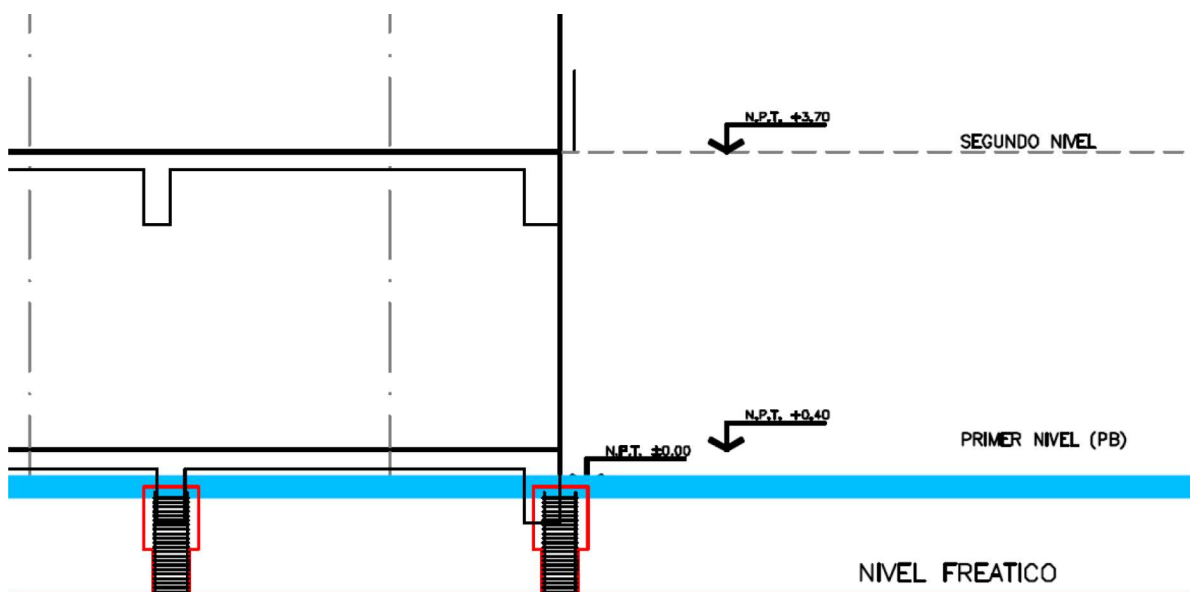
Detalle del plano de cortes y fachadas del proyecto donde se observa la plataforma de construcción sobre los pilotes y su elevación a 0.4 m sobre el nivel del suelo.
